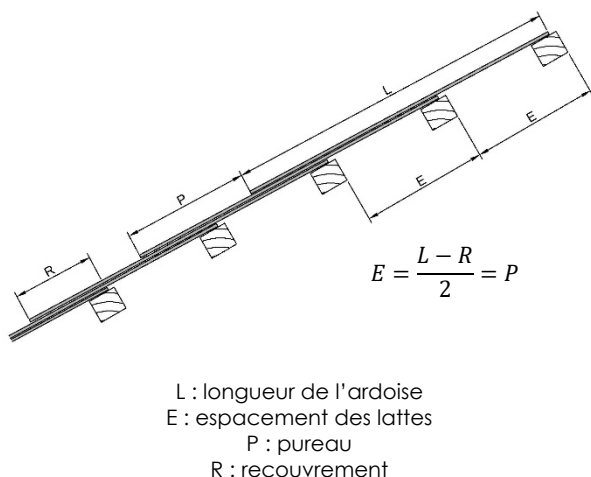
Recouvrement en fonction de la pente de toiture (principe du recouvrement double)
